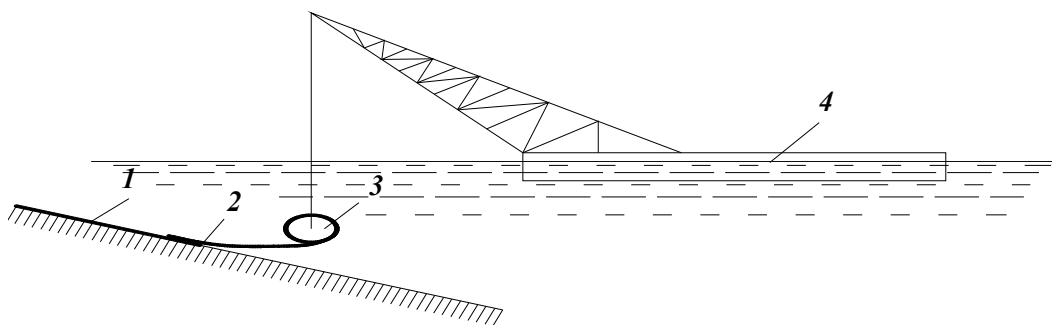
Укладка на откос сборного асфальтобетонного покрытия с барабана:
